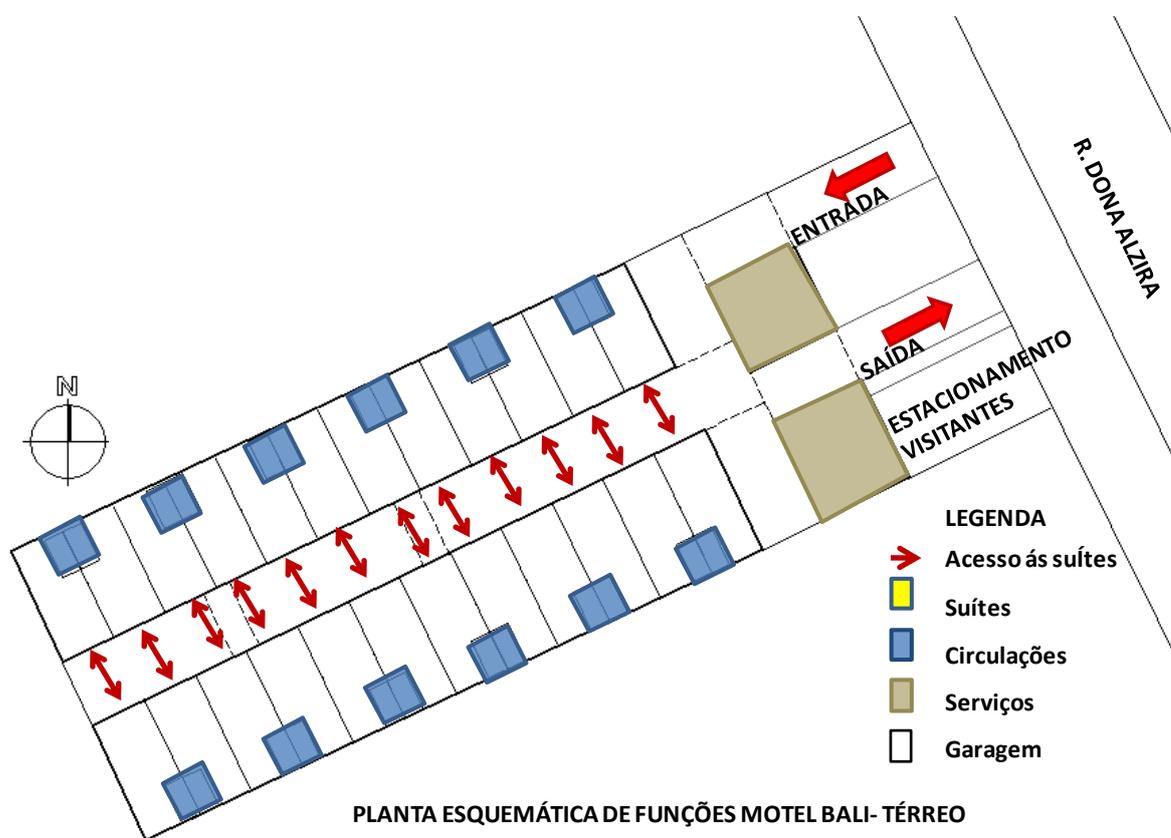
Planta esquemática de funções do térreo do Motel Bali (AUTORA, 2010)
